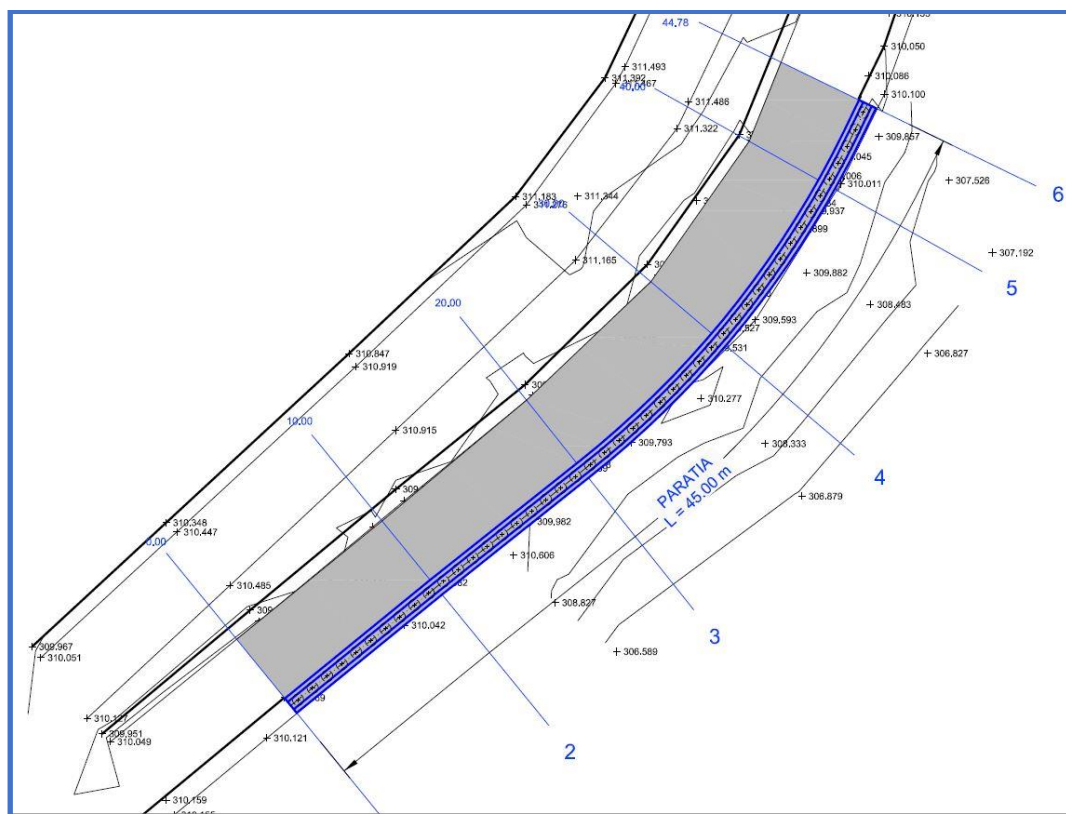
Zona intervento 1 – Planimetria dell'intervento
